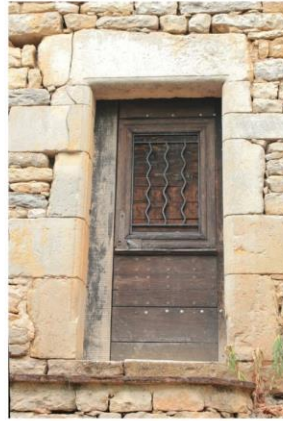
Façade principale, porte du rez-de-chaussée.
